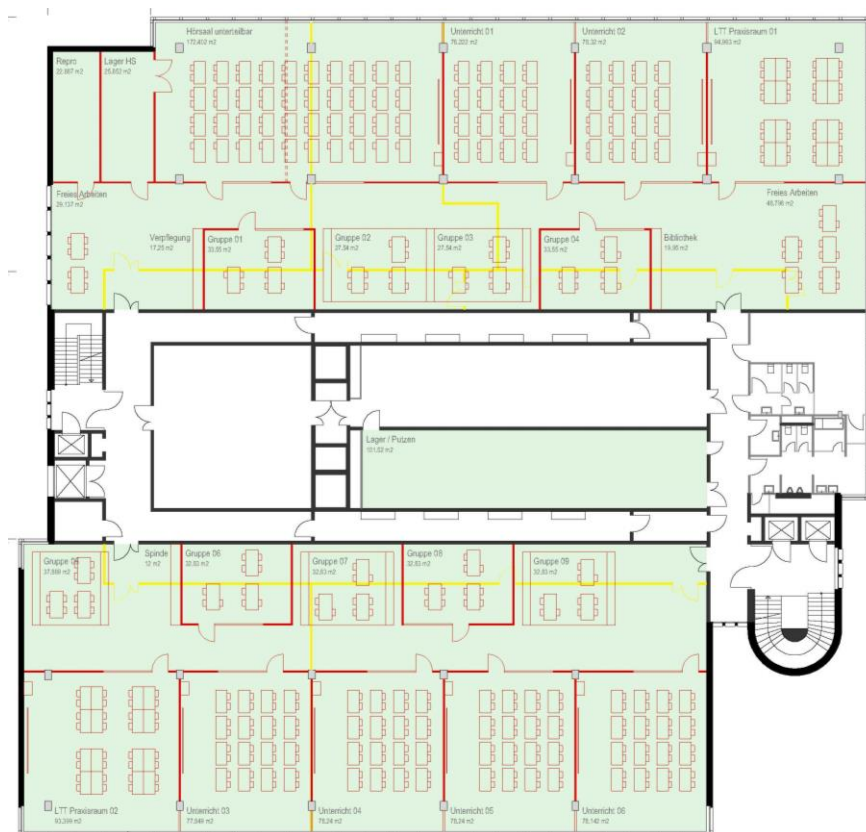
Grundriss Schule auf einem Geschoss, 1. OG: Unterrichtsräume
